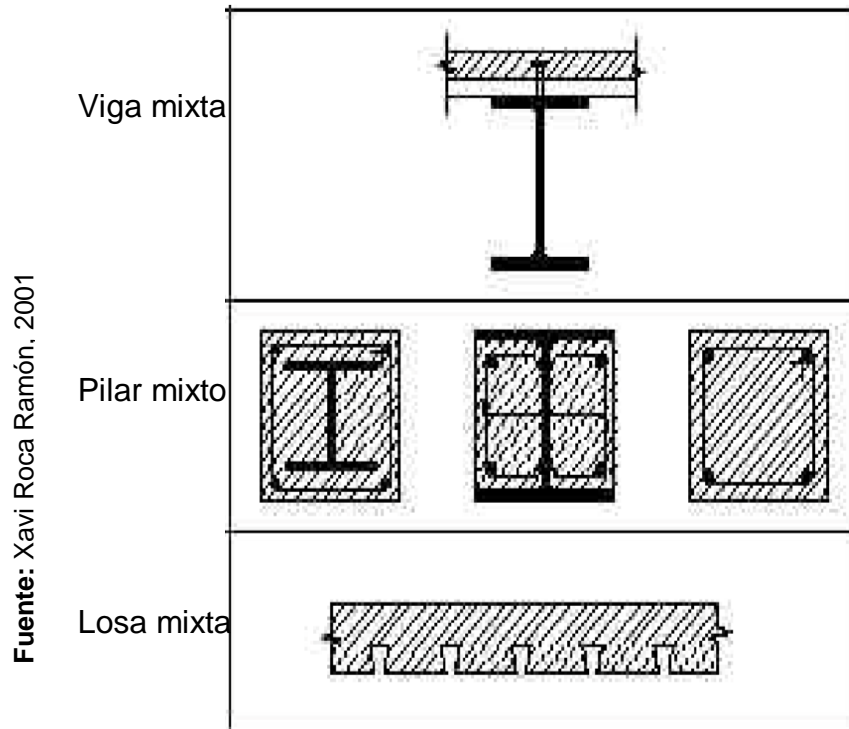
Secciones de viga mixta, pilares mixtos y forjado mixto.
